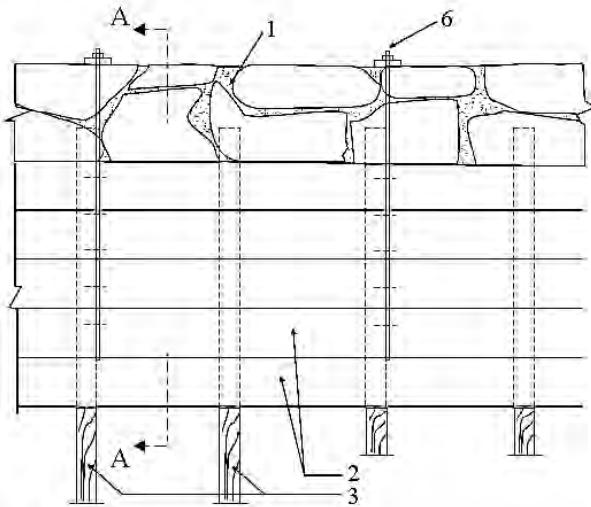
Ojačanje drvene međuspratne konstrukcije armiranobetonom
